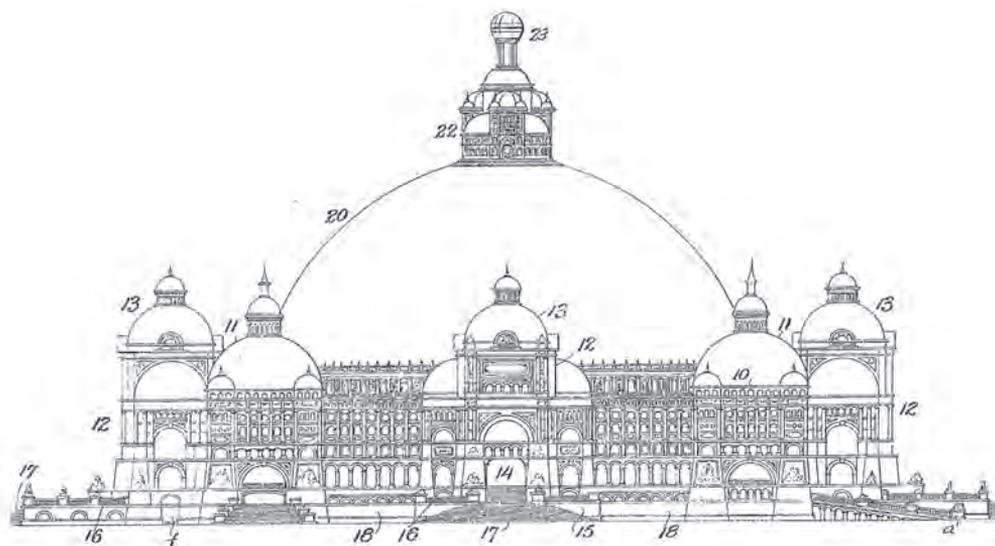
Rafael Guastavino Moreno, 1908. *Structure of Masonry and Steel*, 01.
